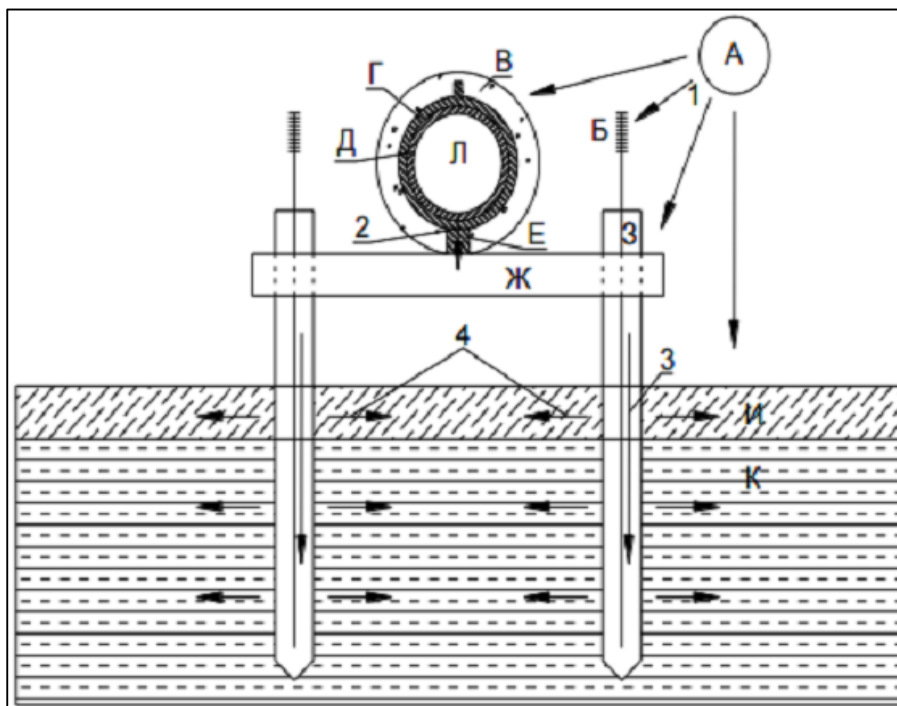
Сечение надземного промыслового газонефтепровода на свайном фундаменте, погруженном в многолетнемерзлый грунт
